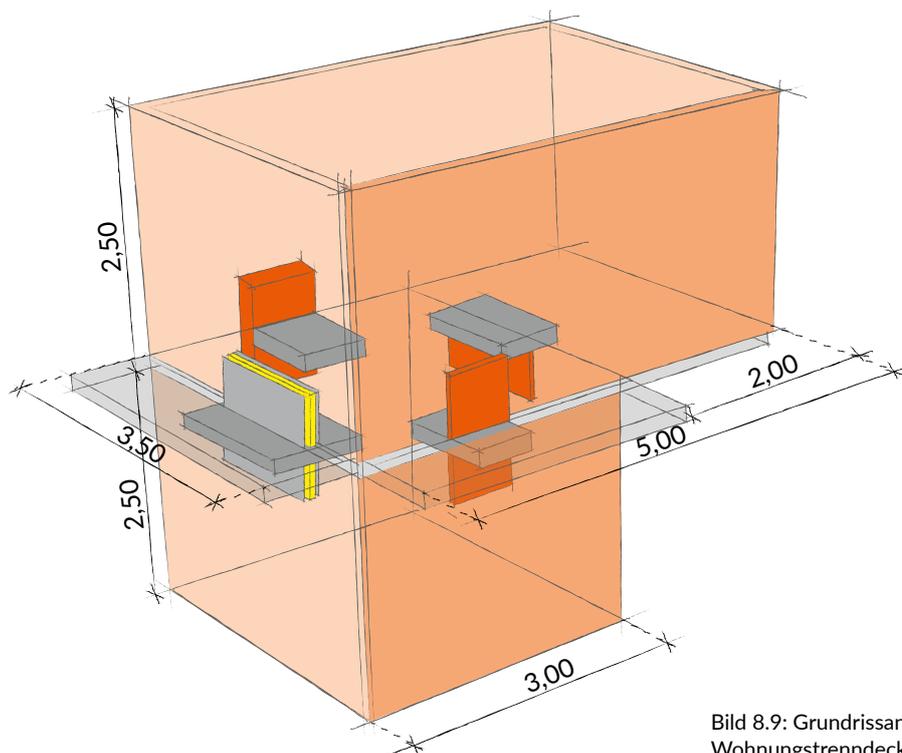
Grundrissanordnung Bemessungsbeispiel Wohnungstrenndecke (Maßangaben in m)
